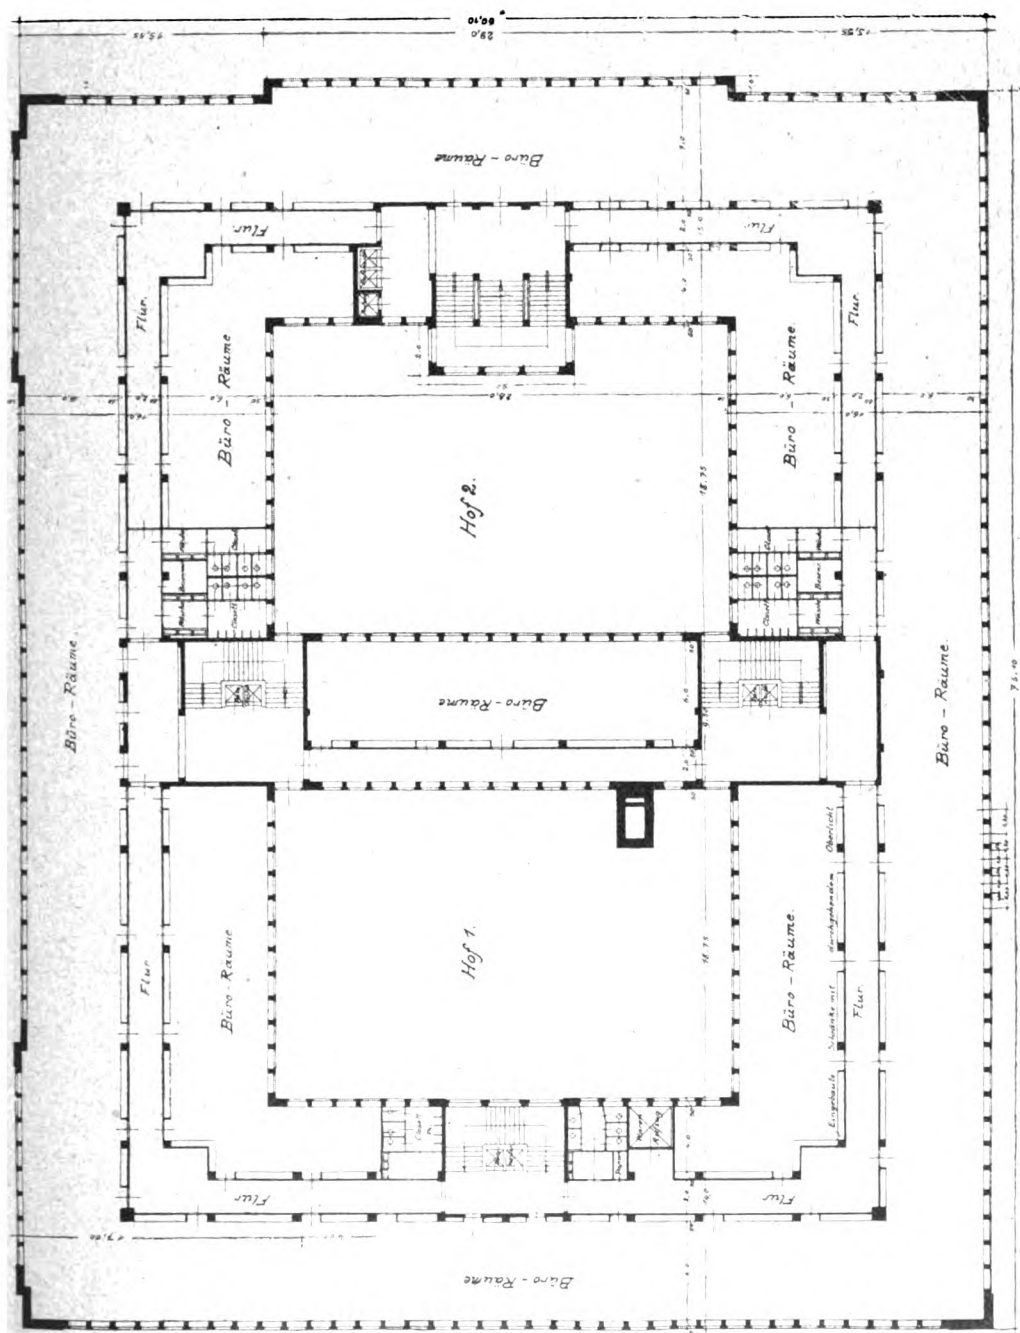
Verwaltungsgebäude der Deutsche Werke A. G., Lageplan.
